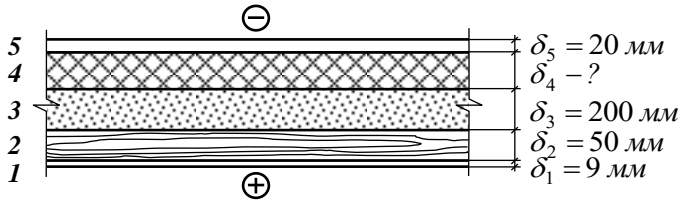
Розрахункова схема конструкції горіщного перекриття (переріз 2-2)
